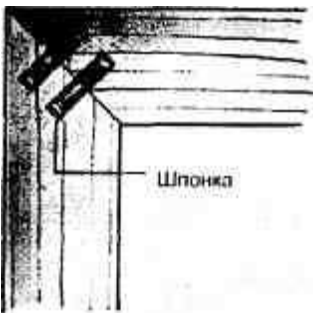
Соединение частей опорной коробки на шип, укрепленное шпонкой.
